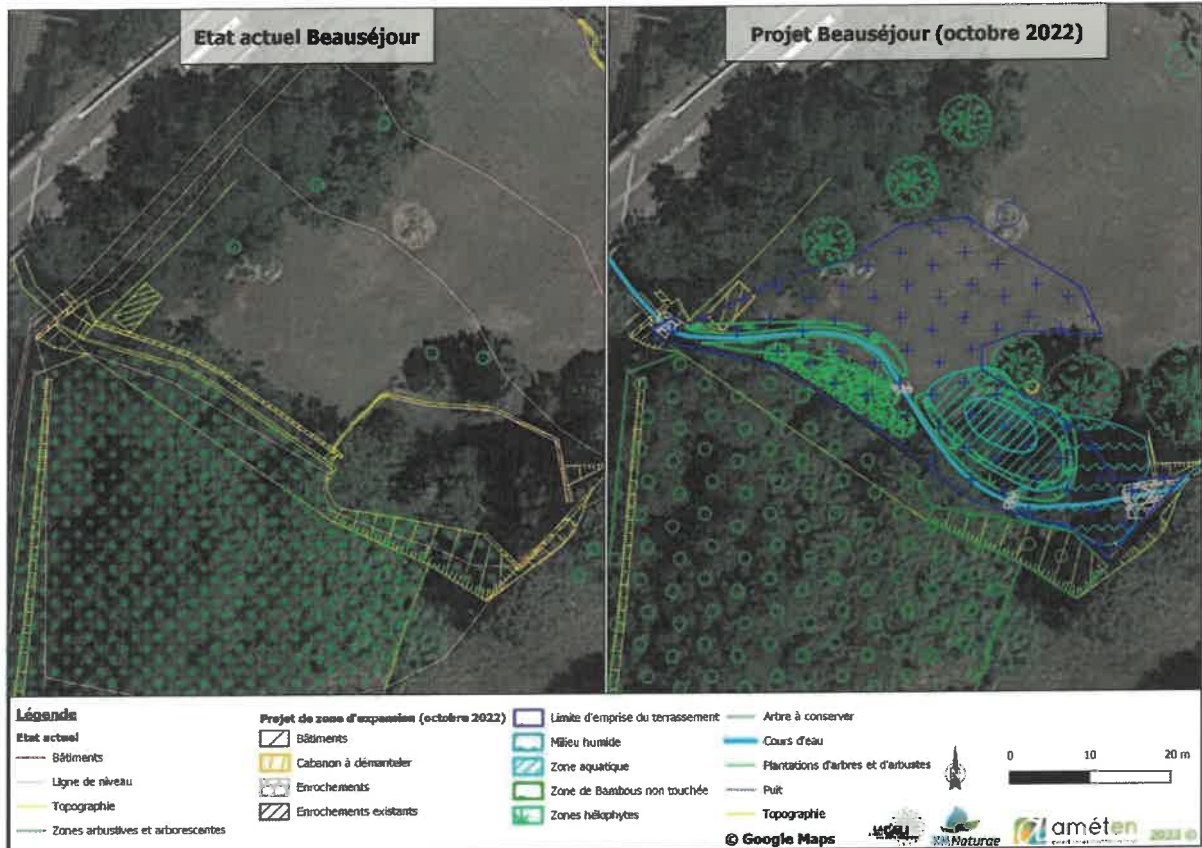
Cartographie du plan de la situation actuelle et du plan projet projeté
